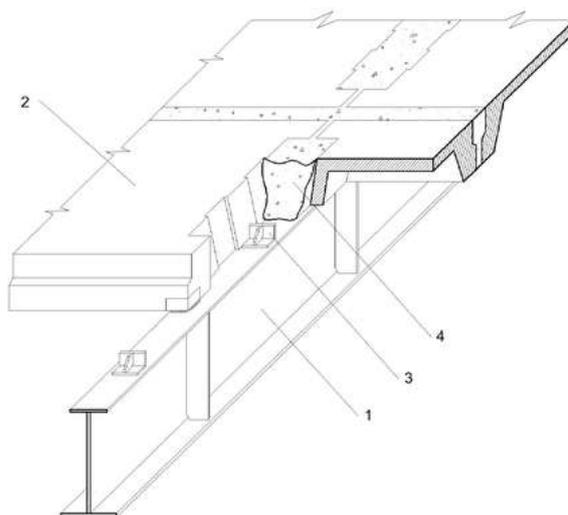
Сталежелезобетонное междуэтажное перекрытие (узел 2) [21]
